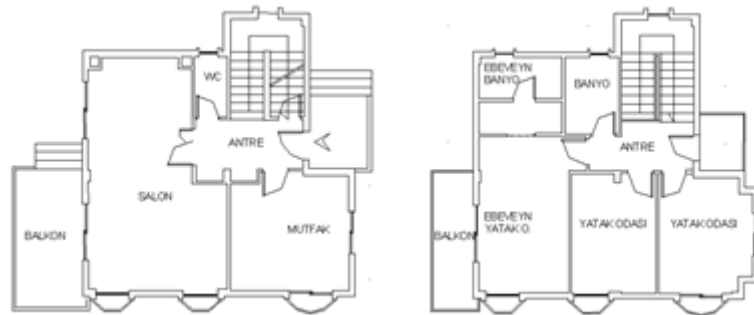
Balcalı Toplu Konutları Plan Tipleri (Aysu, 2011)
